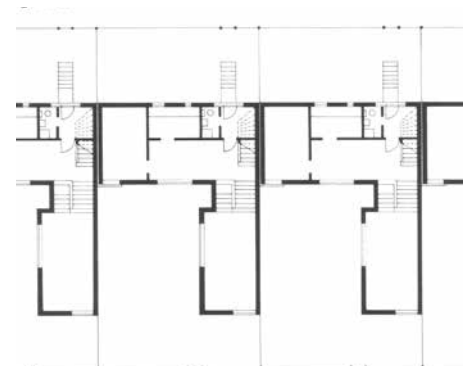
Grundriss Hofhaus, Pilotengasse Wien
